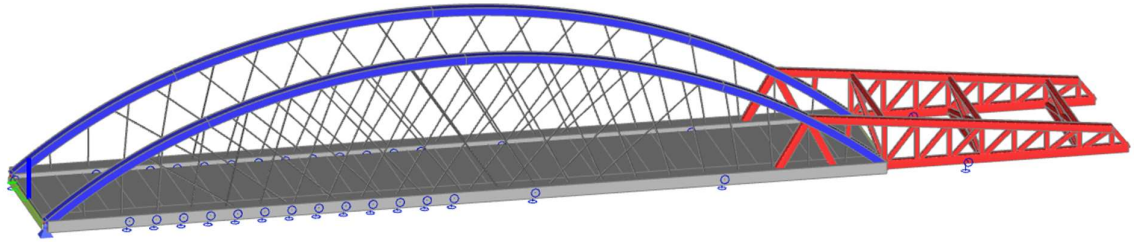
Rozmístění mezilehlých podpor - půdorys
